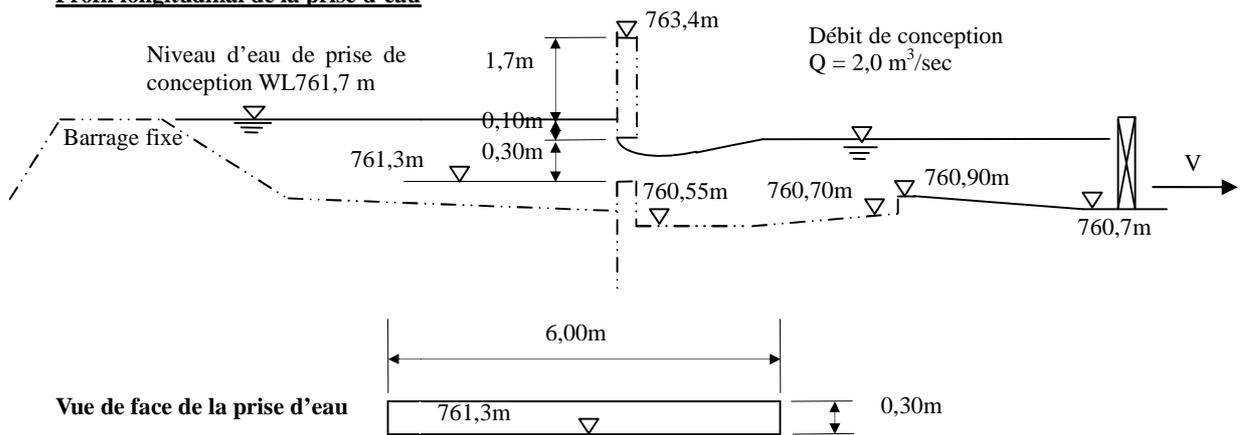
Forme longitudinale et plan de masse de la prise d'eau de la tête de prise d'Andranotsimihoatra
